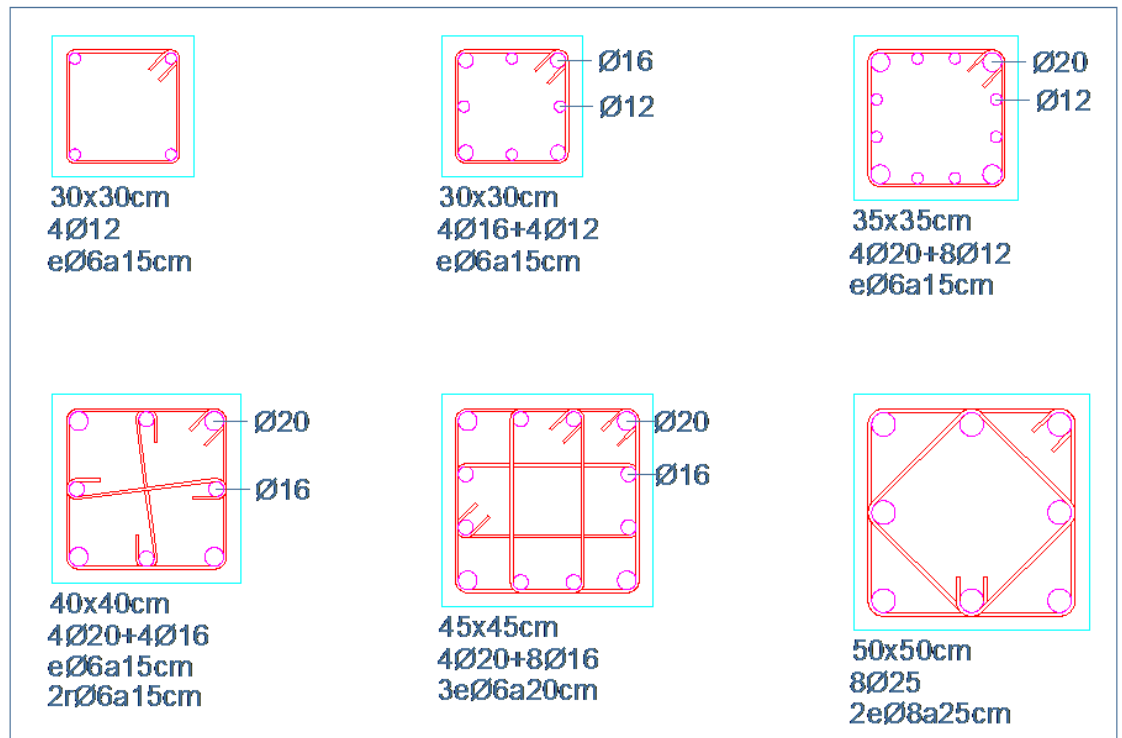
Formas de distribuir los áridos dentro del pilar. DETA09
